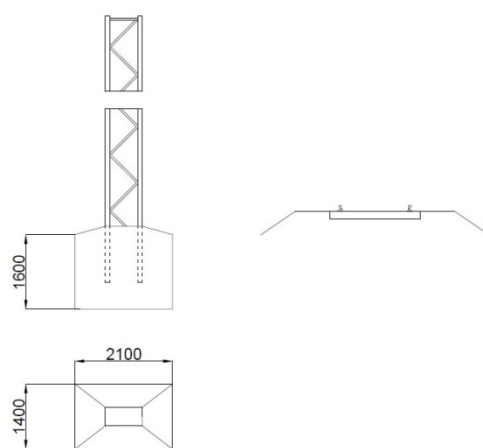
Blocco di fondazione per pali tipo LS (misure in mm)
